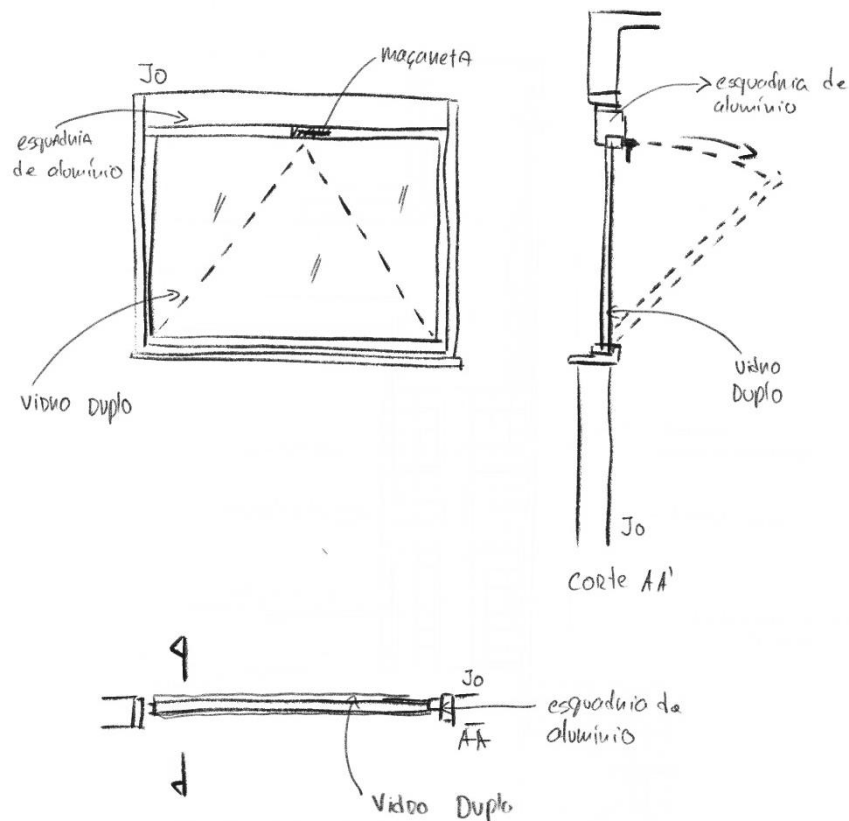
Pormenor construtivo de acabamento das janelas (JO)
